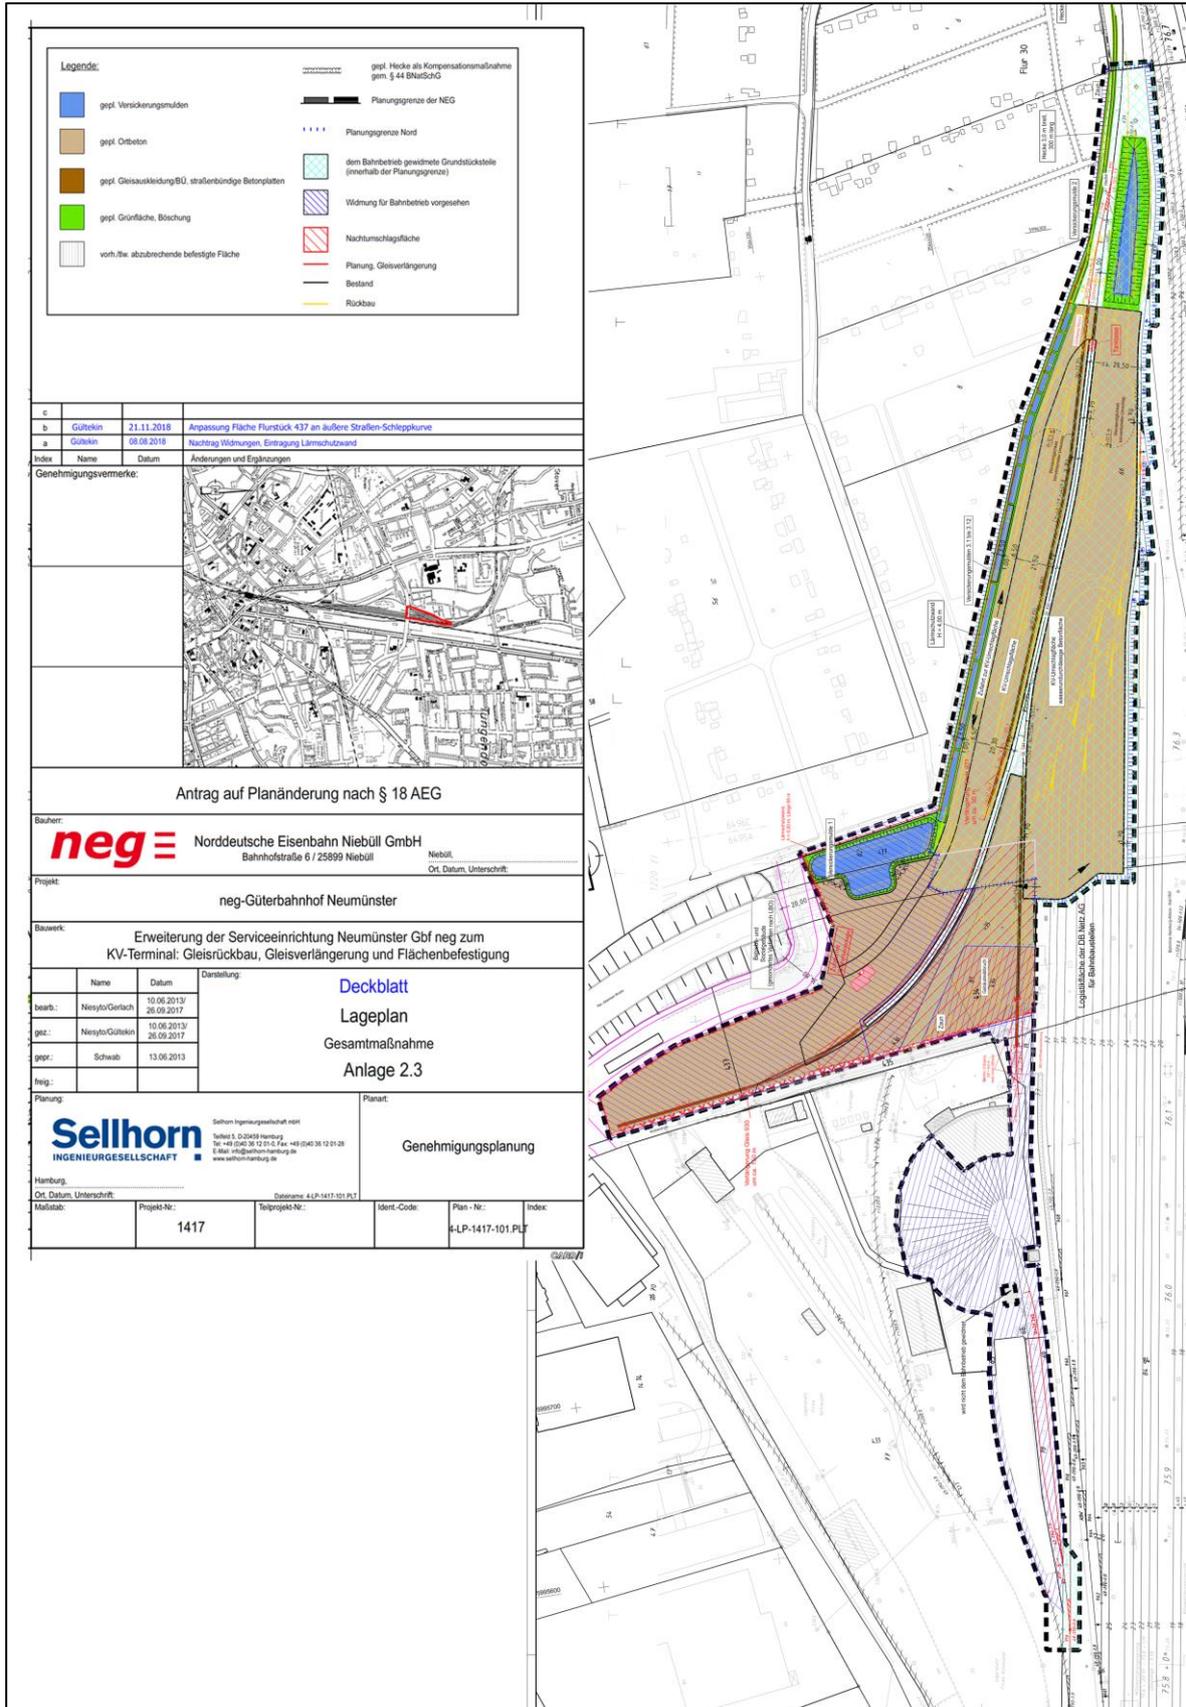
Lageplan KV-Terminal aus Planfeststellungsverfahren
